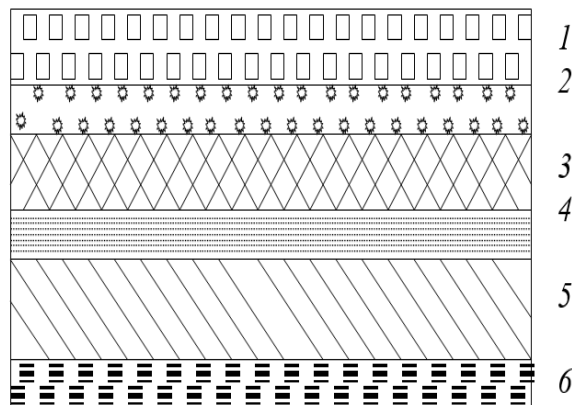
Coupe verticale du plancher sous-sol (dalle pleine)
